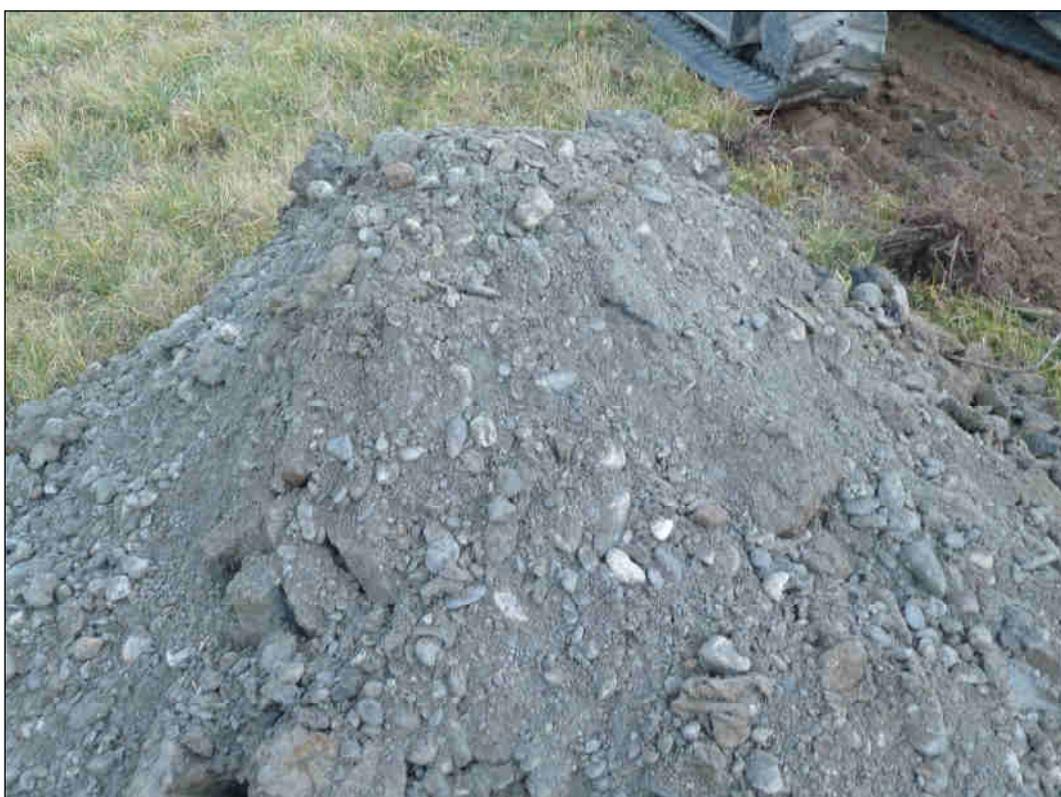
Pozzetto n. 4. Lente locale di ghiaione con ciottoli
